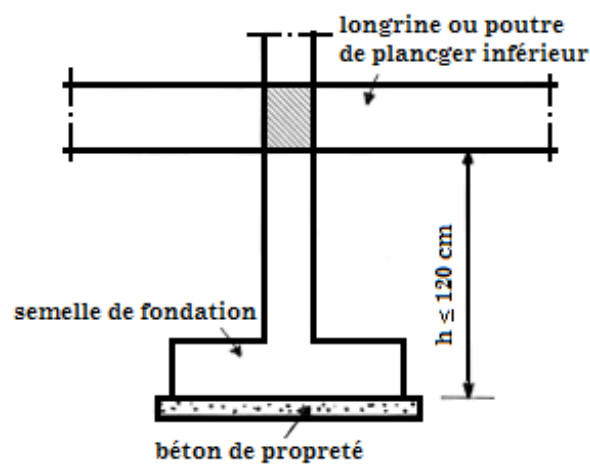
Position des longrines par rapport aux semelles de fondations
